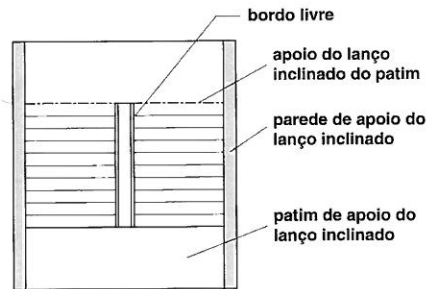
Localização de elementos estruturais de apoio de lanços de escadas
